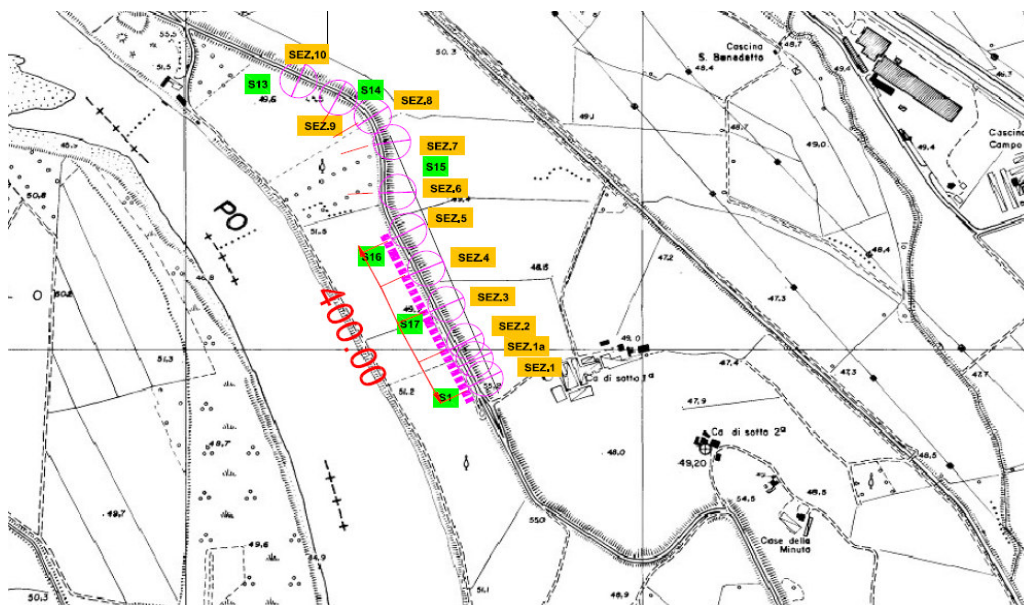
Planimetria con posizione della diaframmatrice (sviluppo 400 m)
